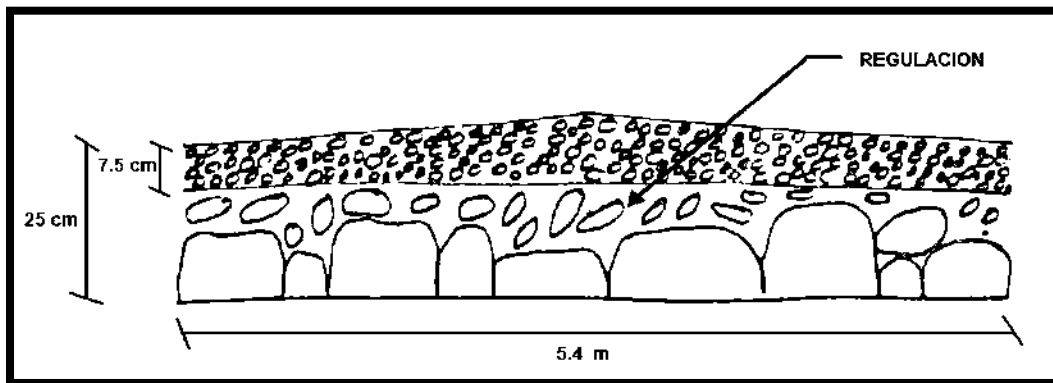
Sección de pavimento tipo propuesta por Pierre-Marie-Jerôme Trésaguet, (Zorio, 1987).
